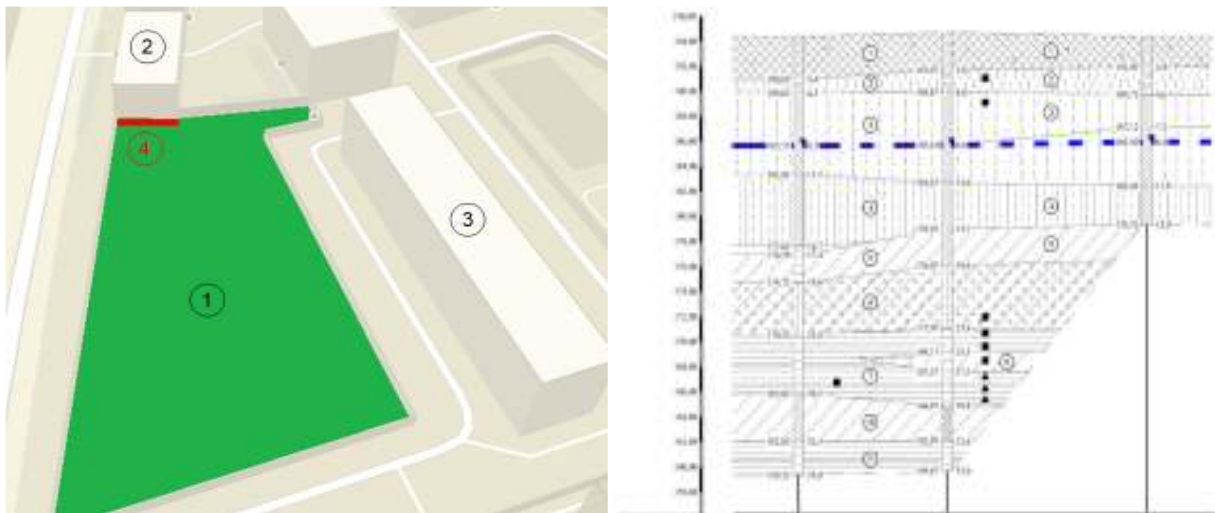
Схематичний план розміщення об'єктів дослідження (а) та інженерно-геологічний розріз майданчика (б): 1 – будівельний майданчик; 2 – прилегла адміністративна будівля; 3 – прилегла житлова будівля; 4 – захисний екран з палей
